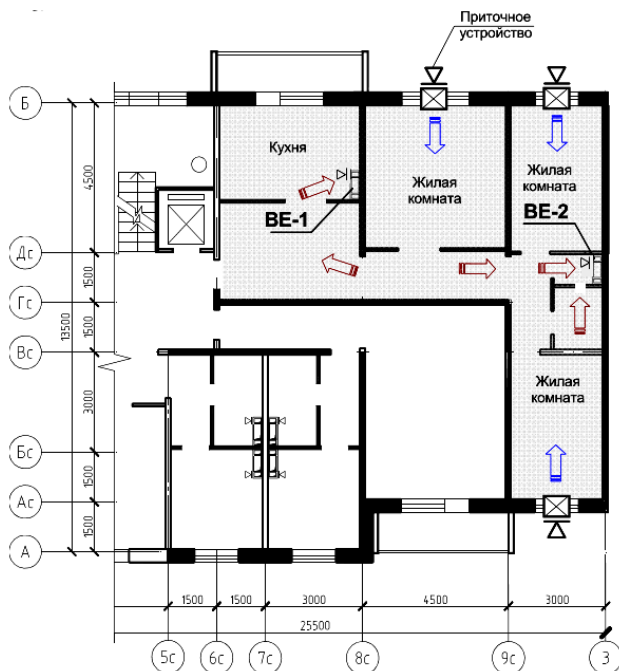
Расстановка приточных и вытяжных вентиляционных устройств в квартире
